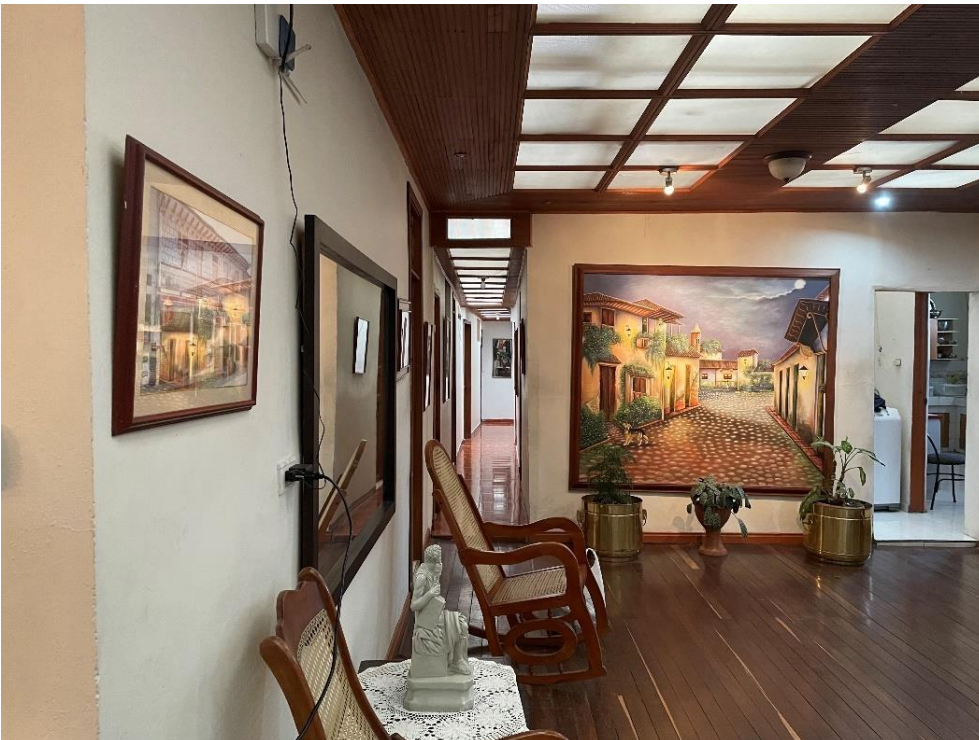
Fotografía donde se evidencia empalme entre bloques. Fuente: elaboración propia.
